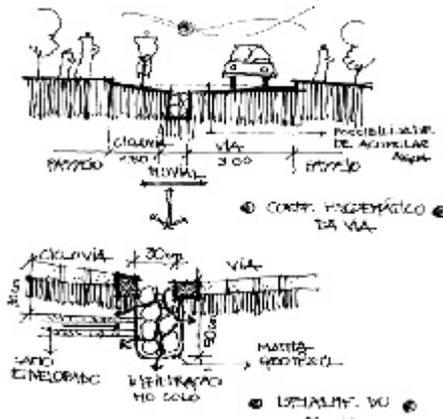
Perfil da rua e detalhe do sistema pluvial
